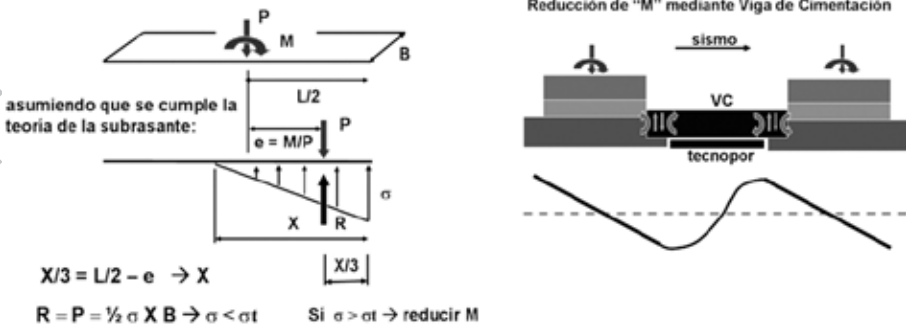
Diseño de la cimentación y viga de cimentación.
